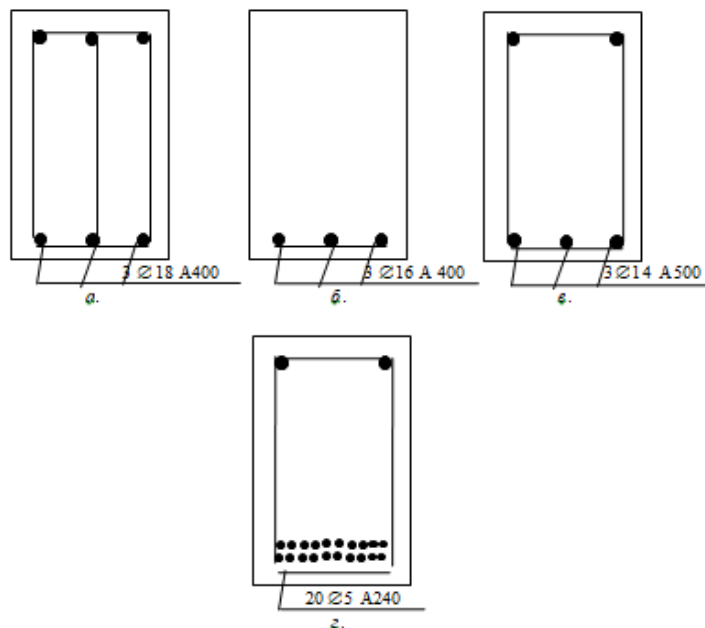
Схеми перерізів залізобетонних балок
